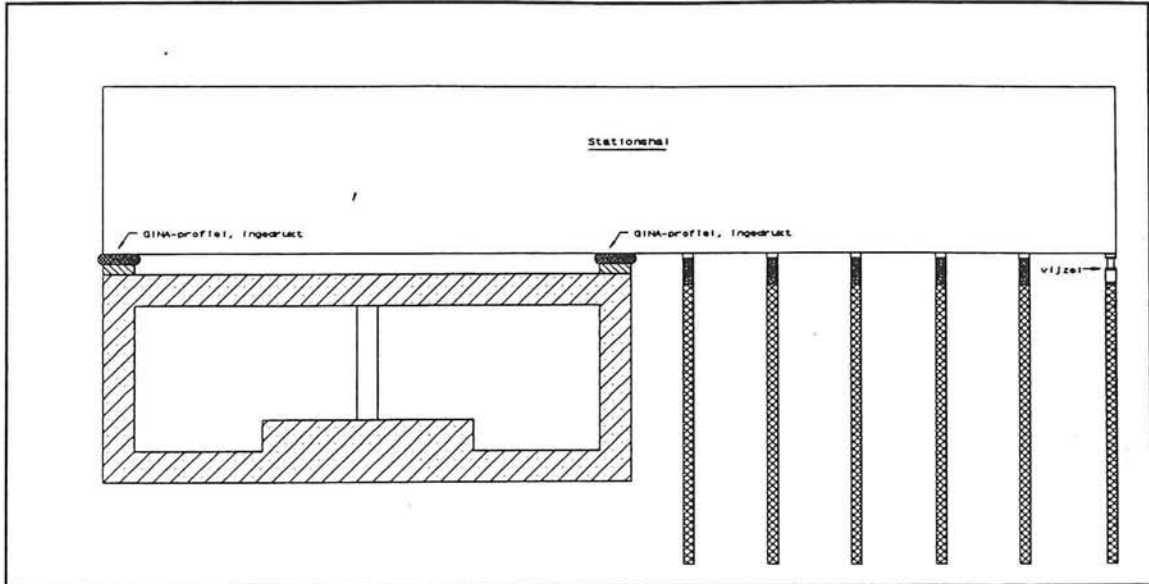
Horizontale aansluiting stationshal op zinkelement.
